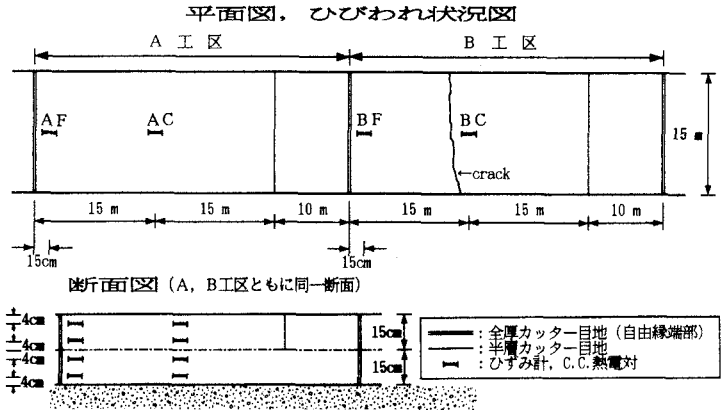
平面図、断面図およびひびわれ発生状況(1990年9月末現在)
